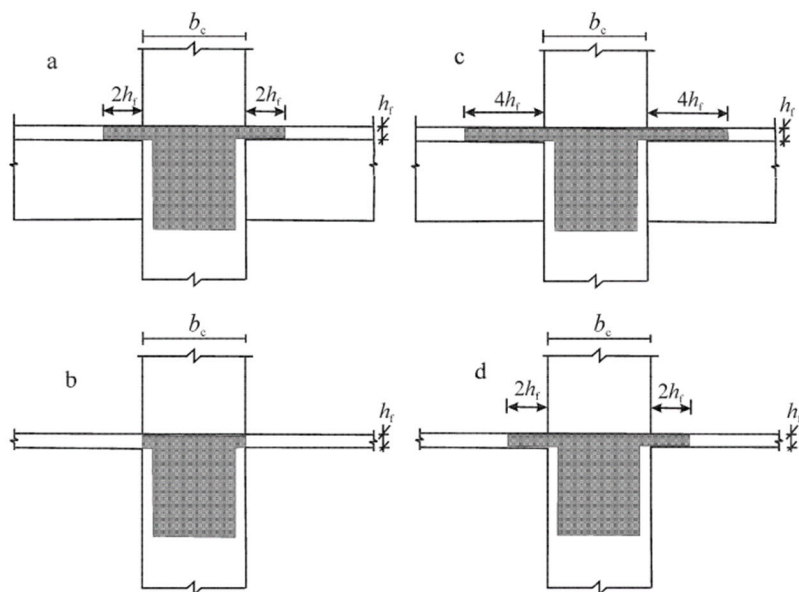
Largura efetiva do banzo b_{eff} para vigas ligadas a pilares (IPQ, 2010)
